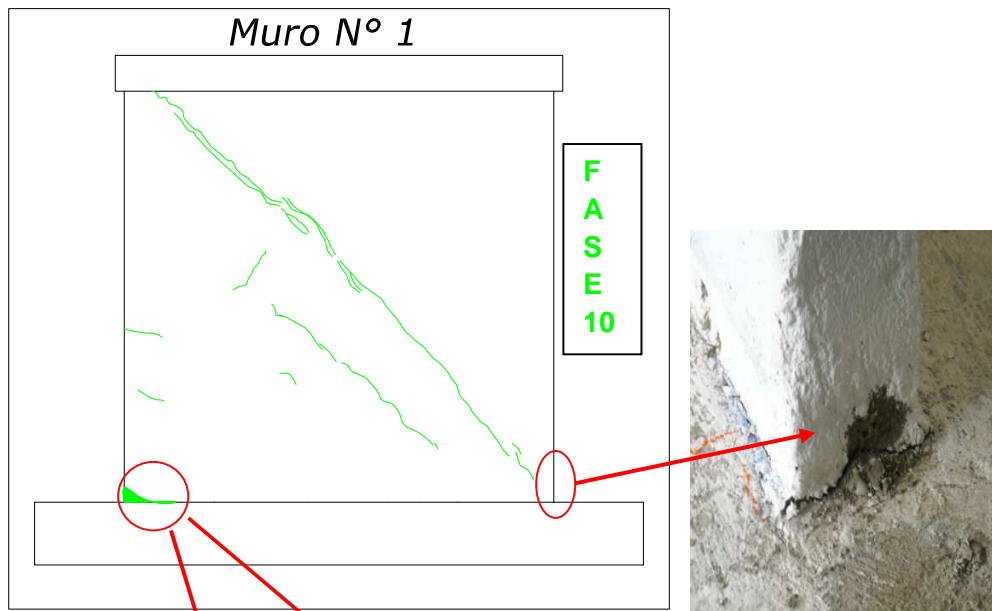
Fisuras en la Fase 10 Muro M-1
